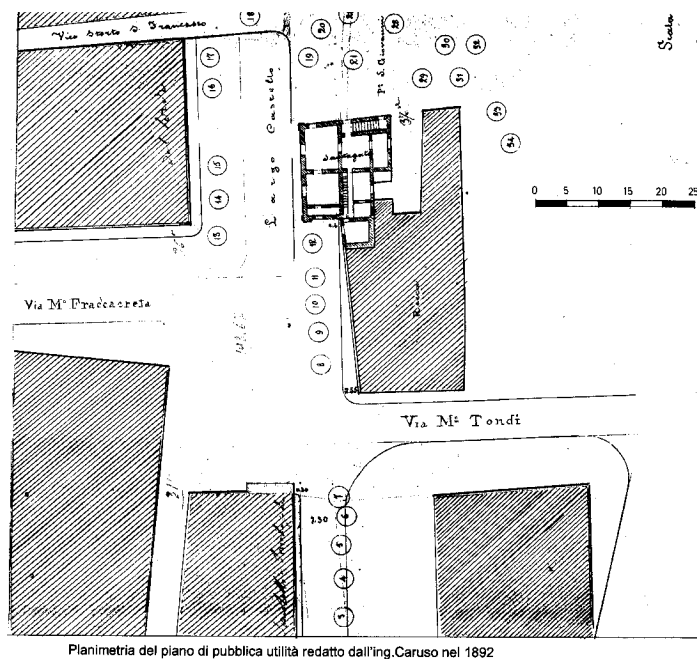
planimetria del lotto prima dei lavori di demolizione dell'ala Tondi nel 1892 (i cerchi numerati indicano le fosse granarie)
